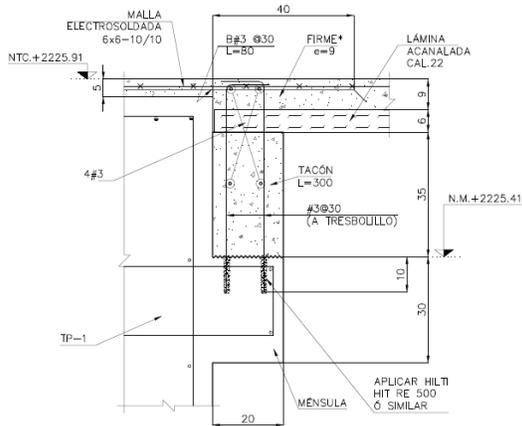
Detalle de anclaje del firme de concreto con losacero en traves portantes.
